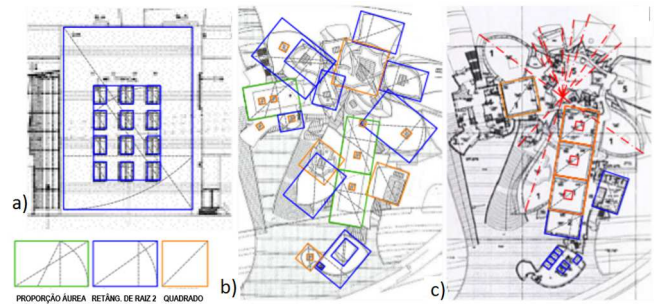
Identificação de proporções em fachada e plantas baixas do Museu Guggenheim: a) Elevação Leste parcial do volume prismático; b) planta de Implantação; c) planta do 2º nível. Fonte: Borda & Rocha, 2016, p.16.
